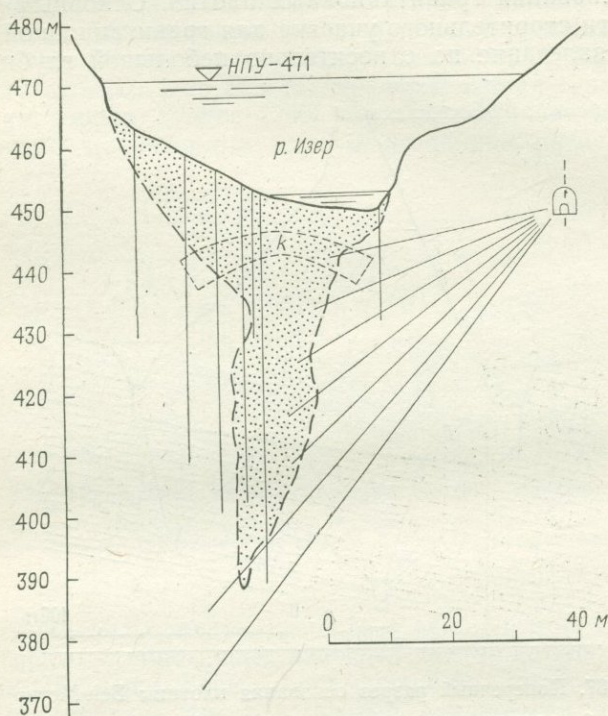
Плотина на реке Изер в Савойе с железобетонным сводом в основании [60].
